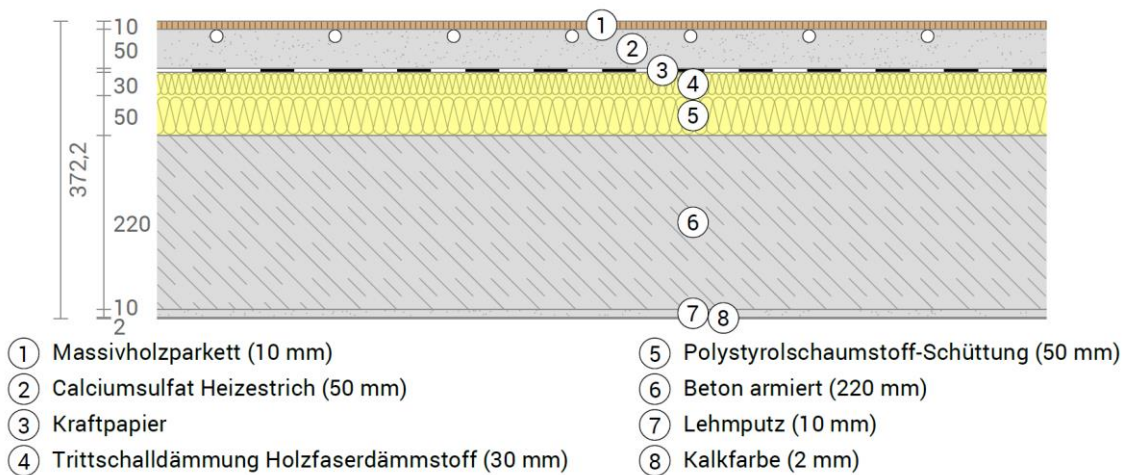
Bauteilaufbau der Geschossdecke im Wohnbereich (KFK-Variante)
